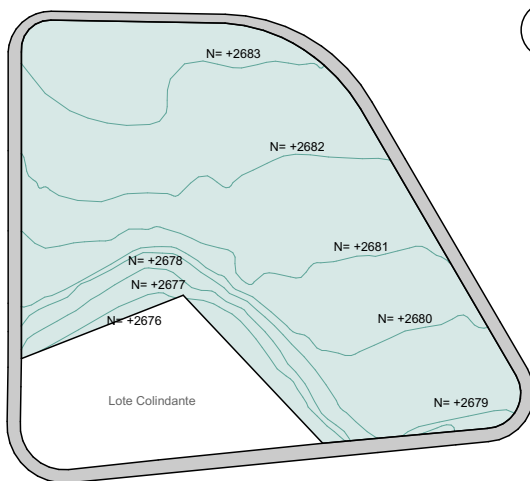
Planta Topografía. Fuente: Autores.
